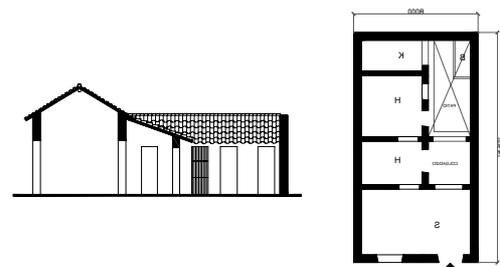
Merced 205 – 207, casas gemelas. Planta, sección y fachada
